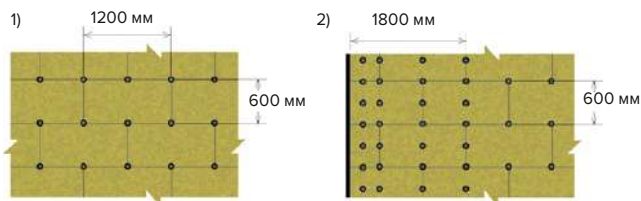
Схема установки гибких связей в системе слоистой кладки: 1) в основном поле стены, 2) в углу здания
